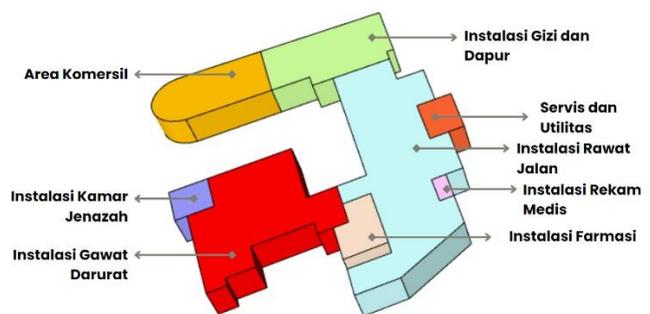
Zonasi Bangunan pada Lantai Dasar
